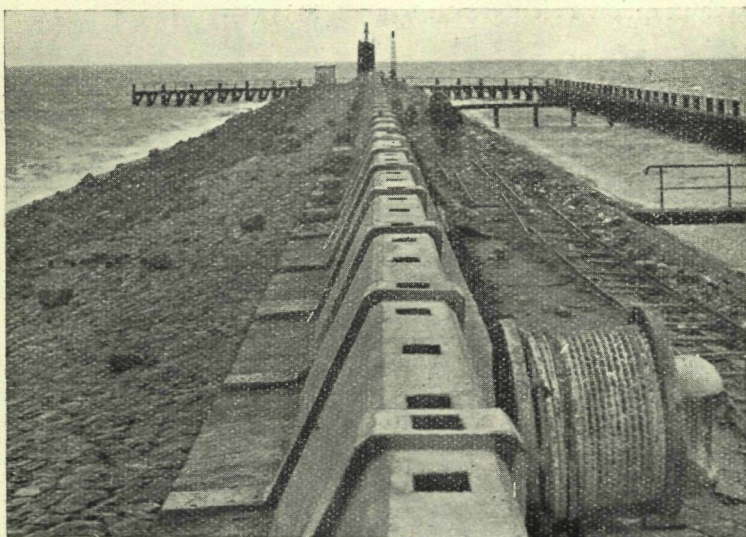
Exhaussement d'un brise-lame suivant le nouveau système de Muralt.
